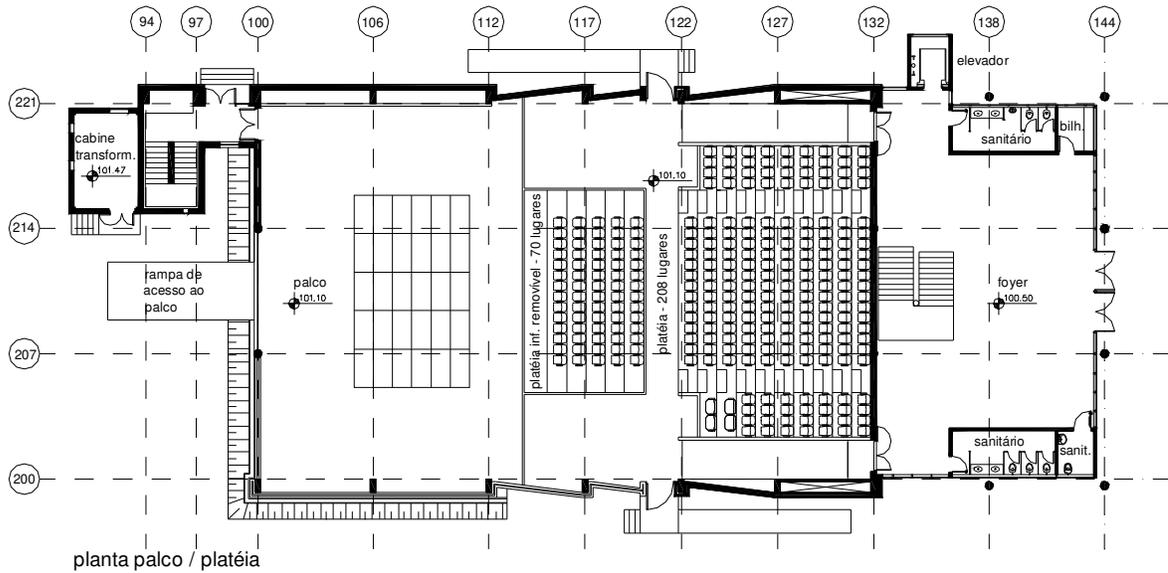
Planta do Pavimento Térreo – Teatro Santa Cruz – Sem Escala
